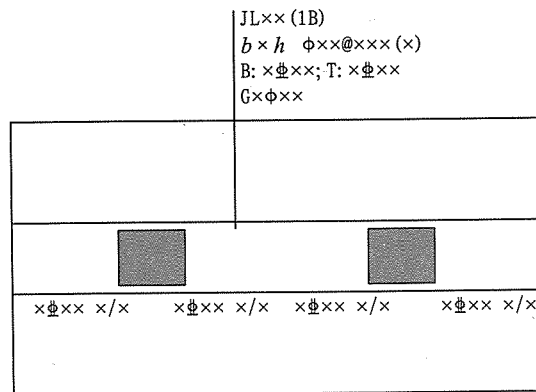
双柱独立基础的基础梁配筋注写示意
